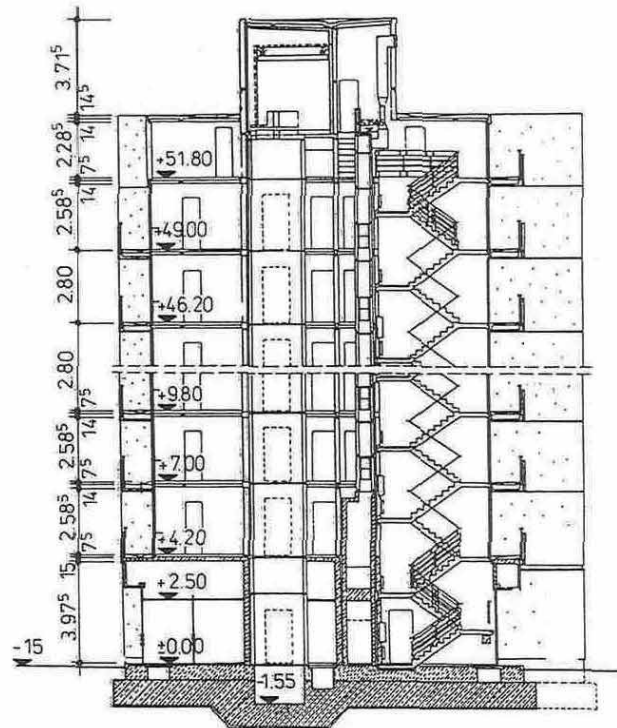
Schnitt durch das WHH GT 18 - Berlin
